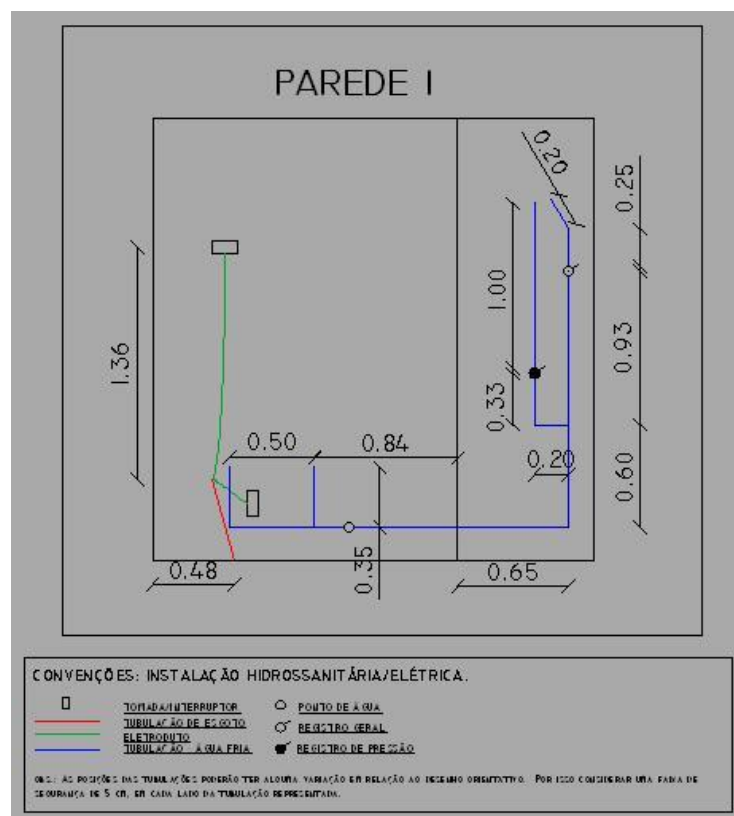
Elevações das instalações do banheiro da suíte.
